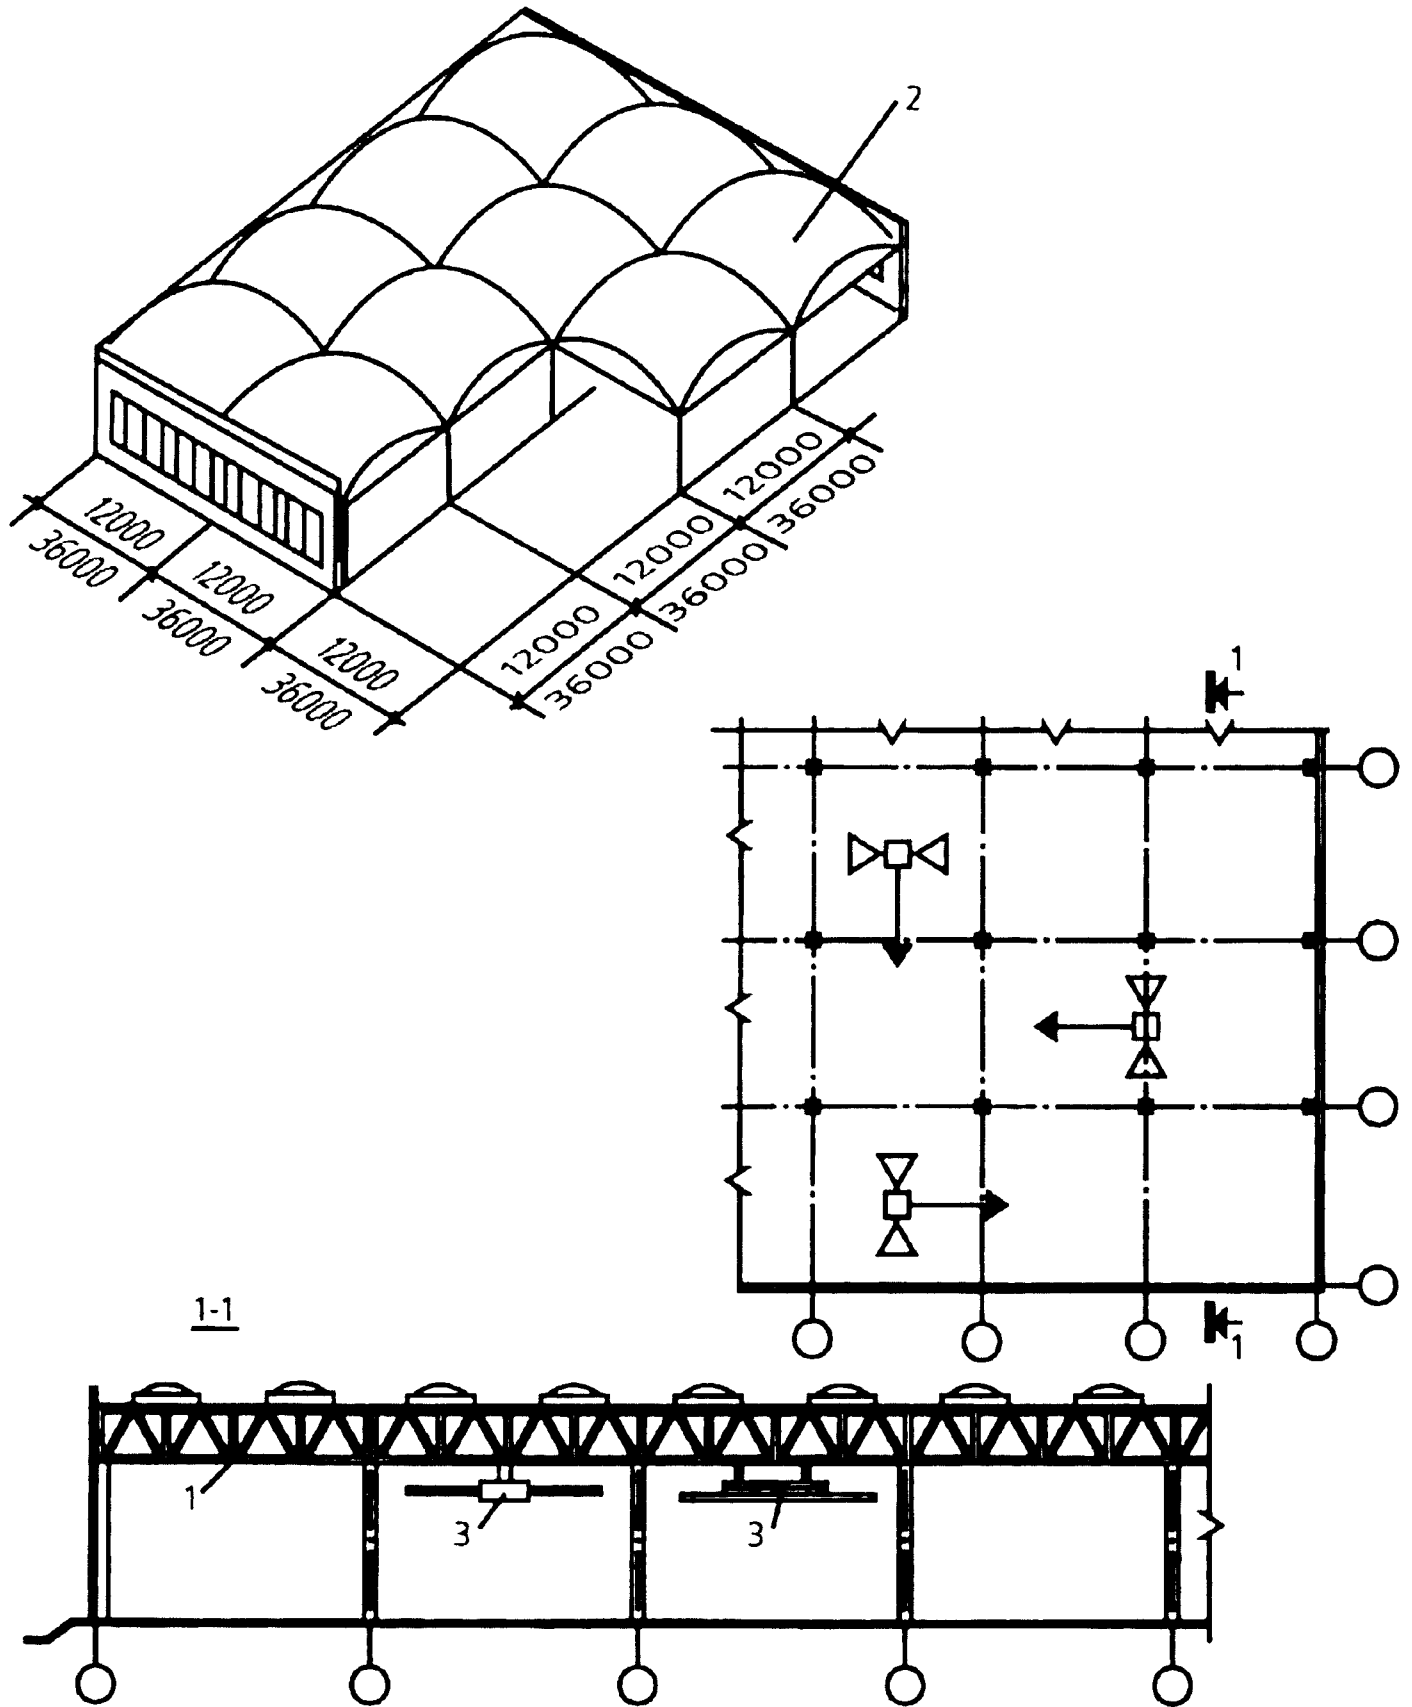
Промышленные здания ячеякового типа: 1 - фермы покрытия; 2 - пространственные конструкции покрытия; 3 - кран-балка
